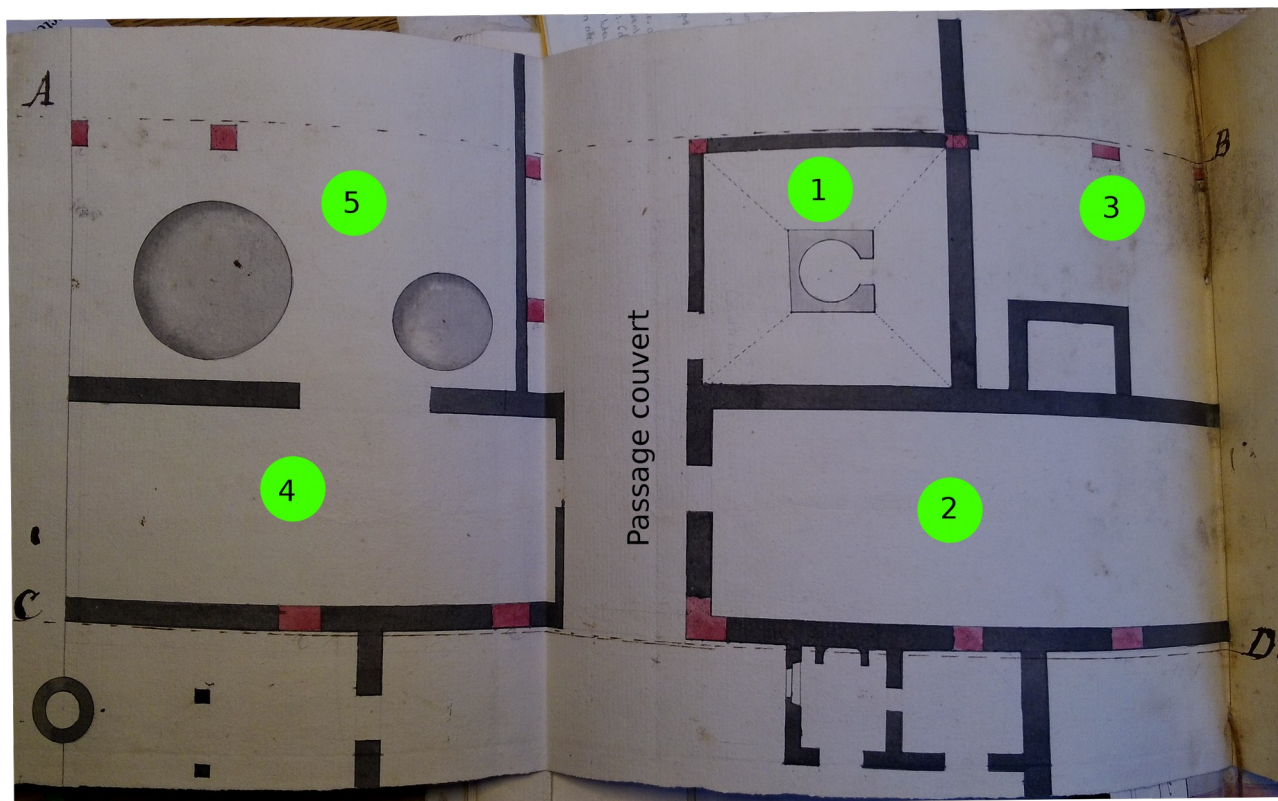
Plan du rez-de-chaussée de la brasserie de Claude Poissant.
